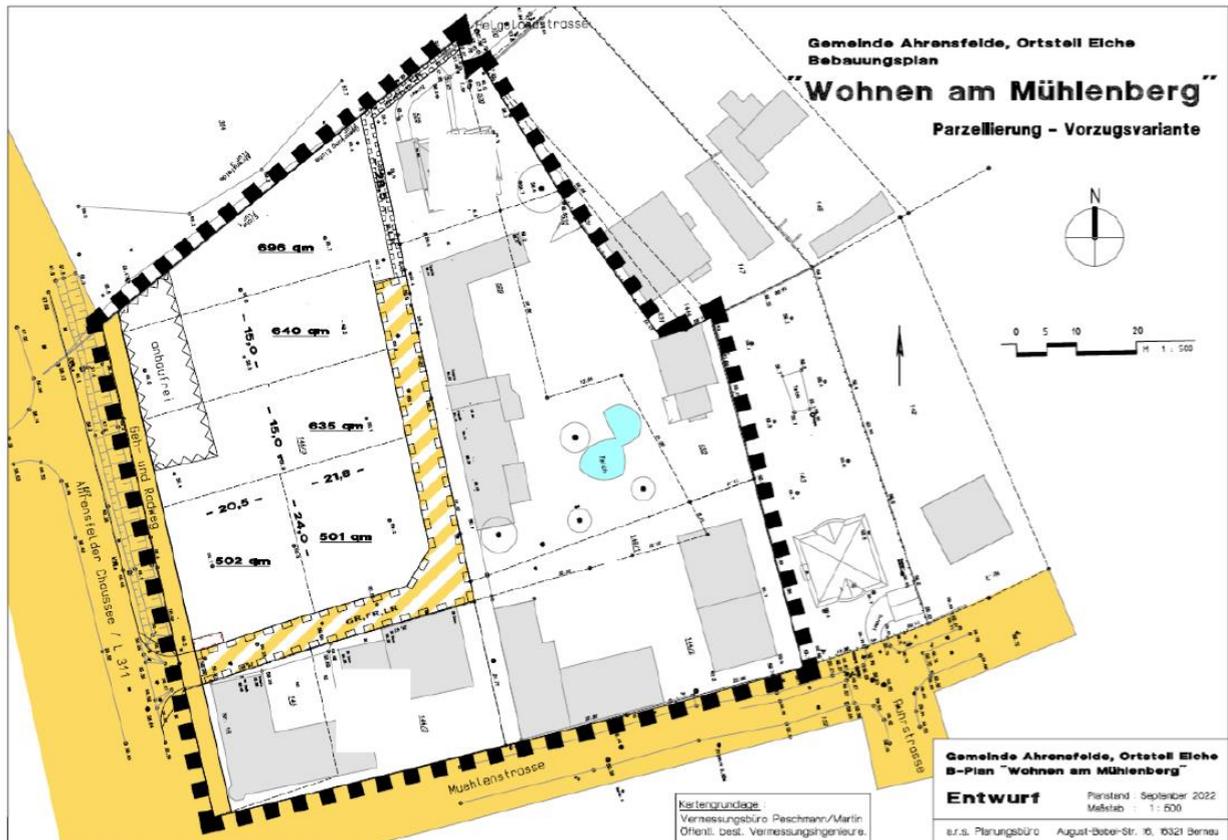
Parzellierung / Vorzugsvariante (A.R.S. PLANUNGSBÜRO 2022)
